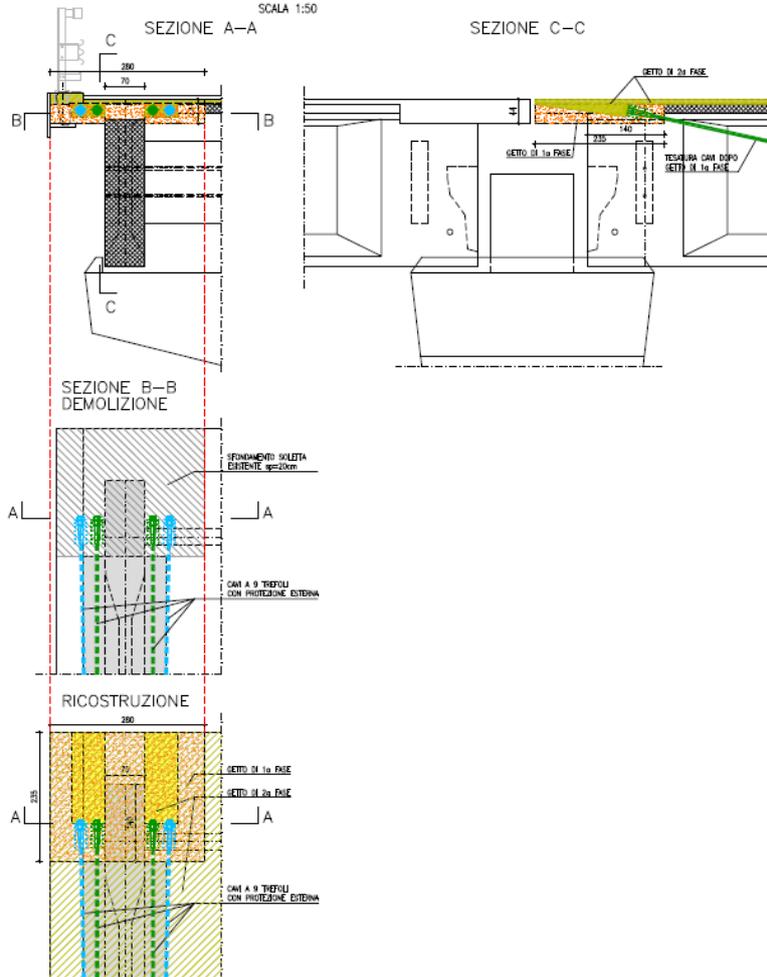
Interventi di consolidamento delle travi con 2+2 cavi di precompressione
